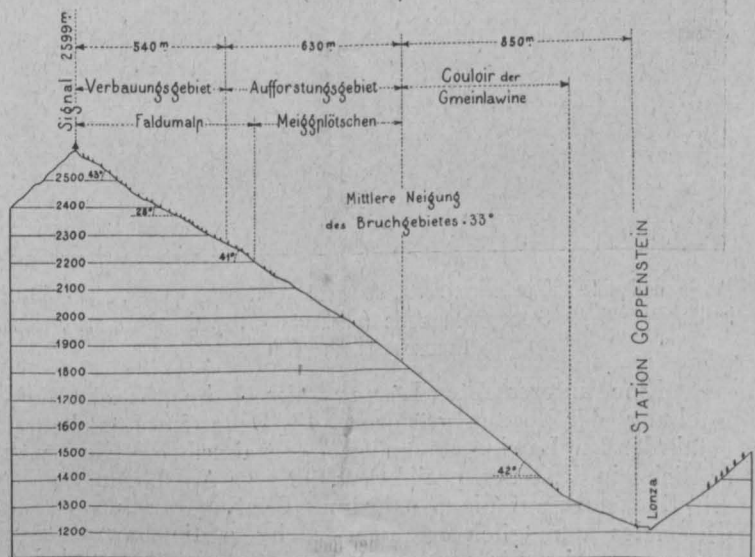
Längenprofil im Lawinenzug der Gemeinlawine
